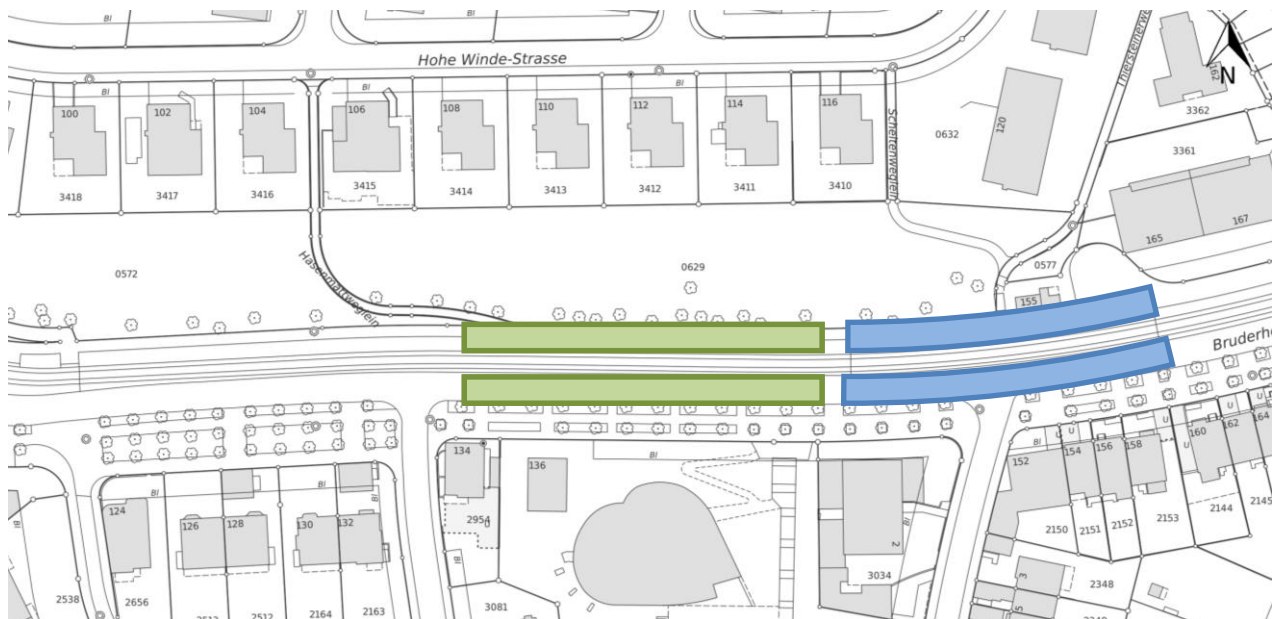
Haltestelle Bruderholz (blau: Bestand; grün: Projekt)
